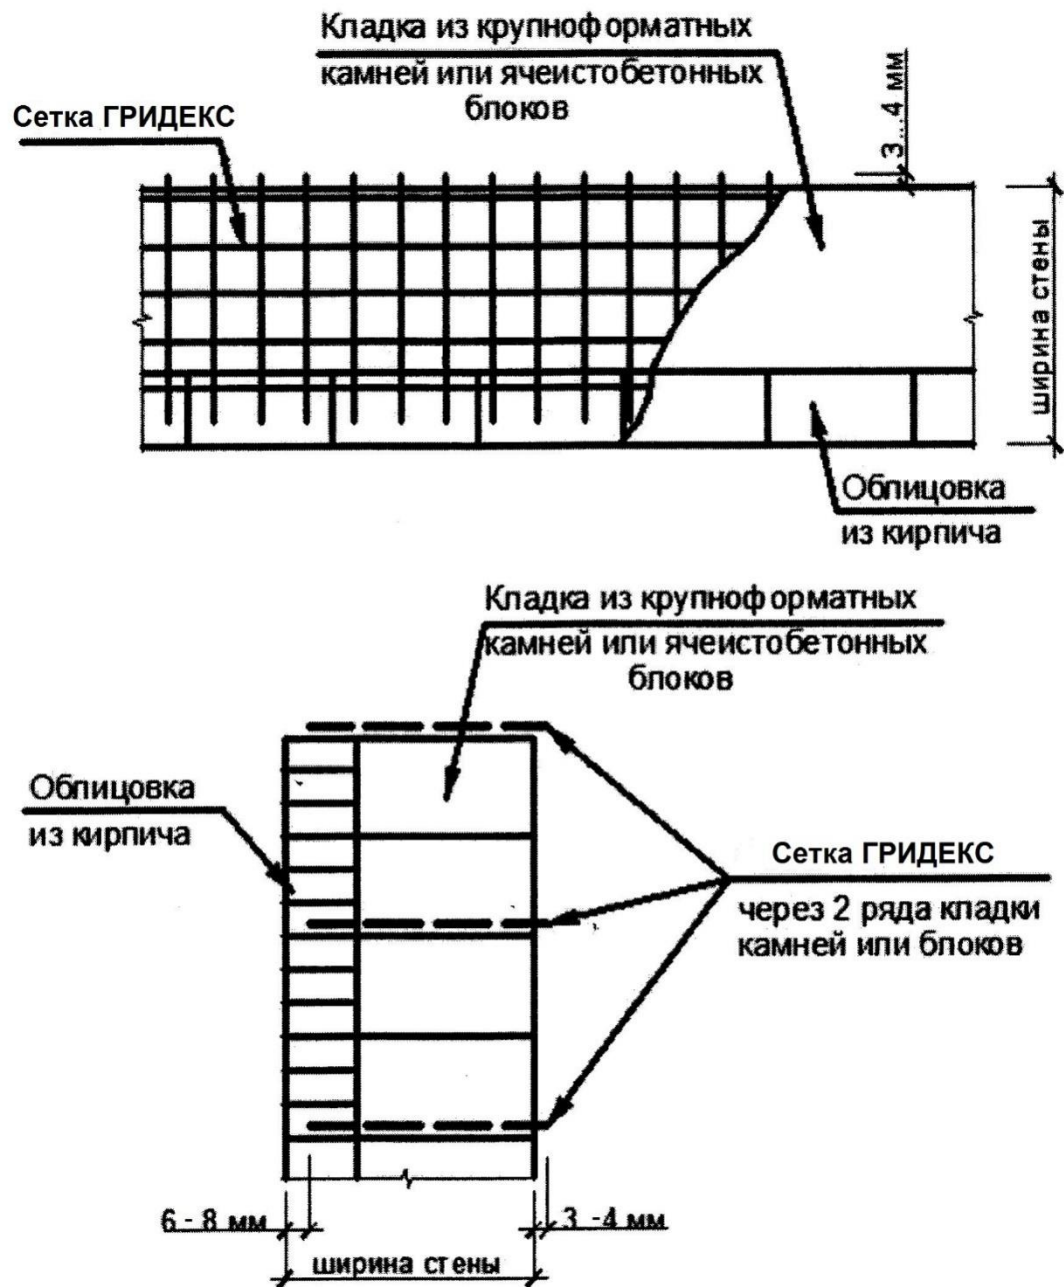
Схема соединения наружного (из кирпича) и внутреннего (крупноформатный камень, ячеистобетонные блоки) слоев двухслойной кладки с помощью связевой сетки
